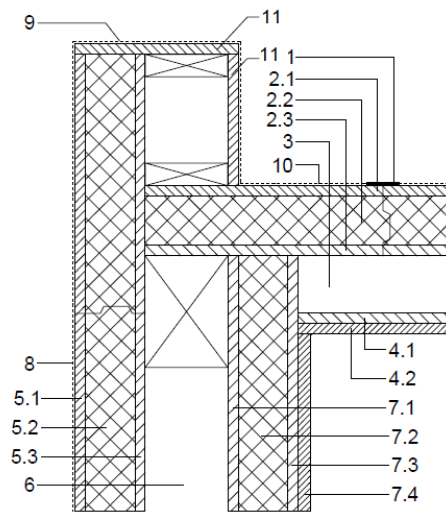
Encuentro tipo de fachada formada con paneles SATE y WALL con carpintería y caja de persiana. Sección transversal vertical.
